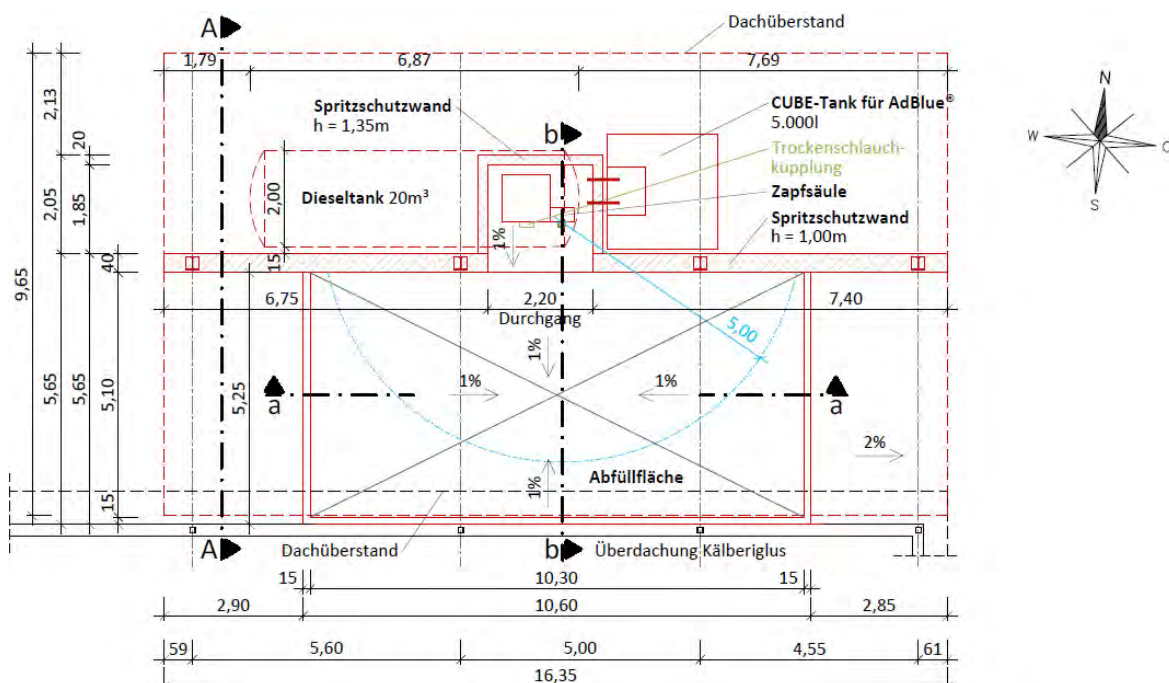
Grundriss der Betriebstankstelle
